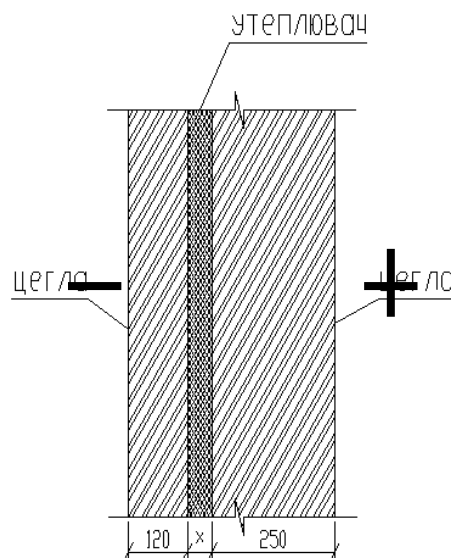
Зовнішня огороджувальна стінова конструкція
